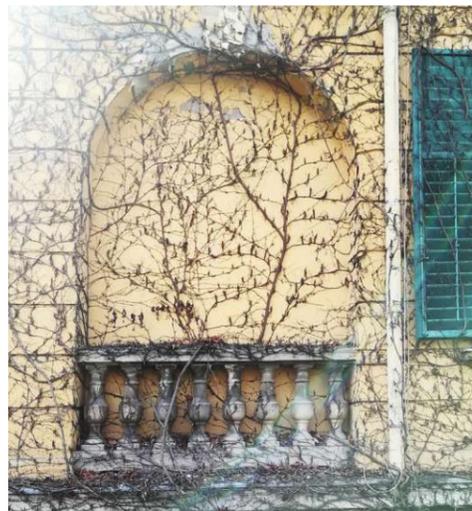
Wasser- und Putzschaden an der Fassade, erneuertes Fallrohr.
